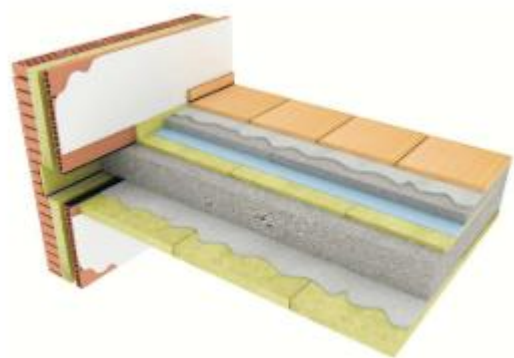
b) – Isolamento de lâ de rocha sob a laje [19]
